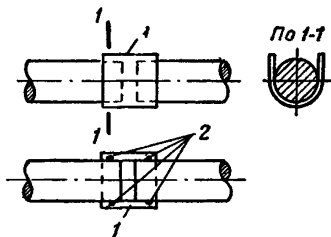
Стык, стержней сборной под ванную сварку
